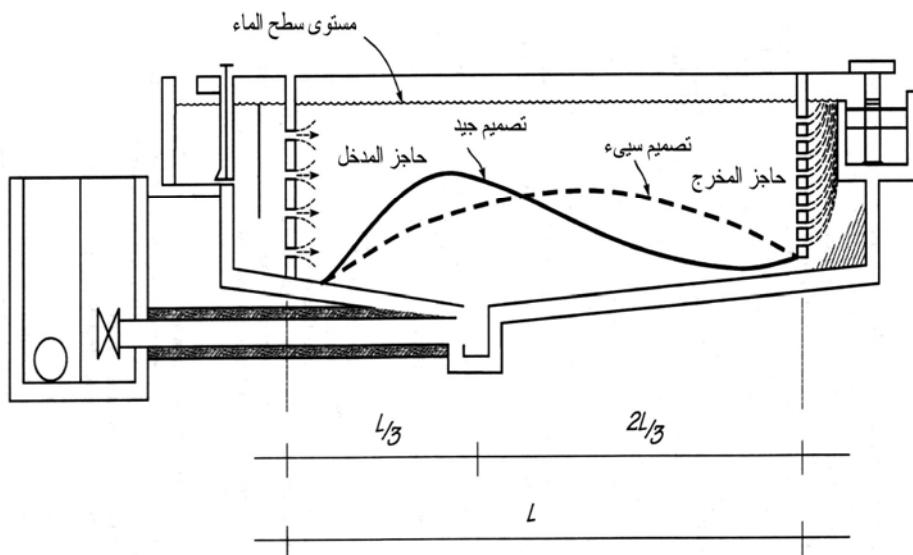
مسقط أفقي لخزان السيب النهائي
